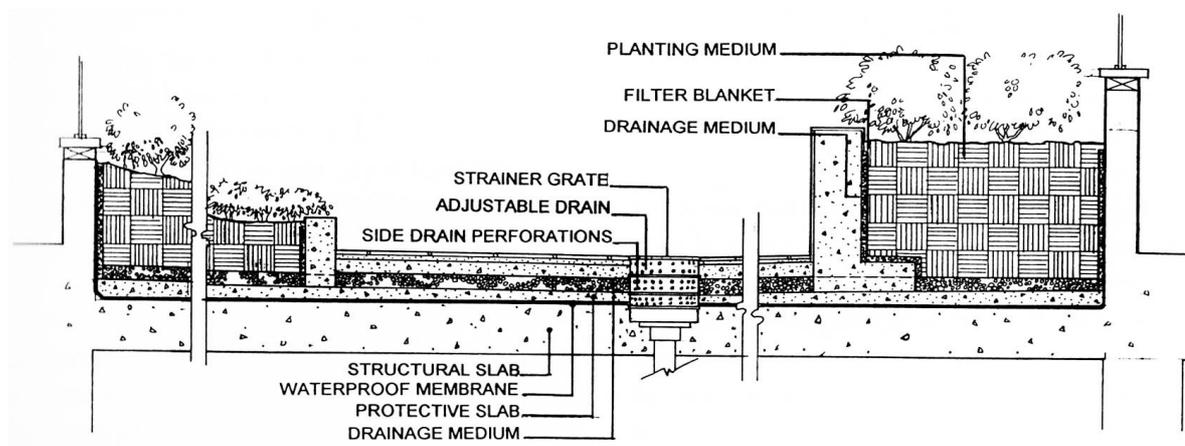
Sistema de drenagem de pavimentos e ligação ao descarregador. Fonte: Osmundson,
